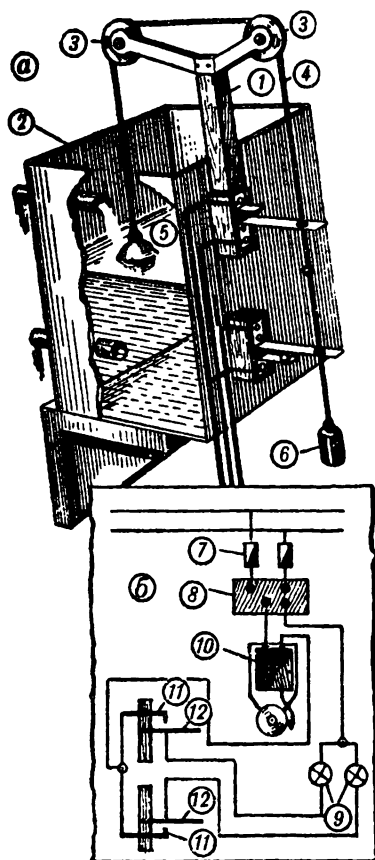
Устройство автоматического сигнализатора уровня воды (а — конструкция; б — электрическая схема): 1 — деревянная рейка; 2 — бак; 3 — блоки; 4 — промасленная бечевка; 5 — поплавки; 6 — груз; 7 — предохранители; 8 — щиток; 9 — лампочки; 10 — звонок; 11 — неподвижные контакты; 12 — подвижные контакты.
